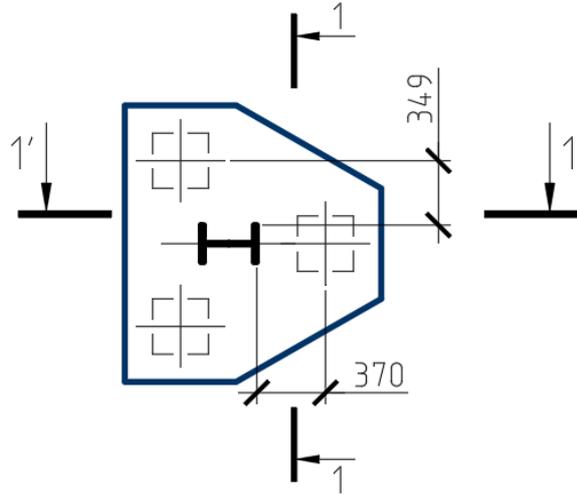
Схема к расчету ростверка на изгиб
